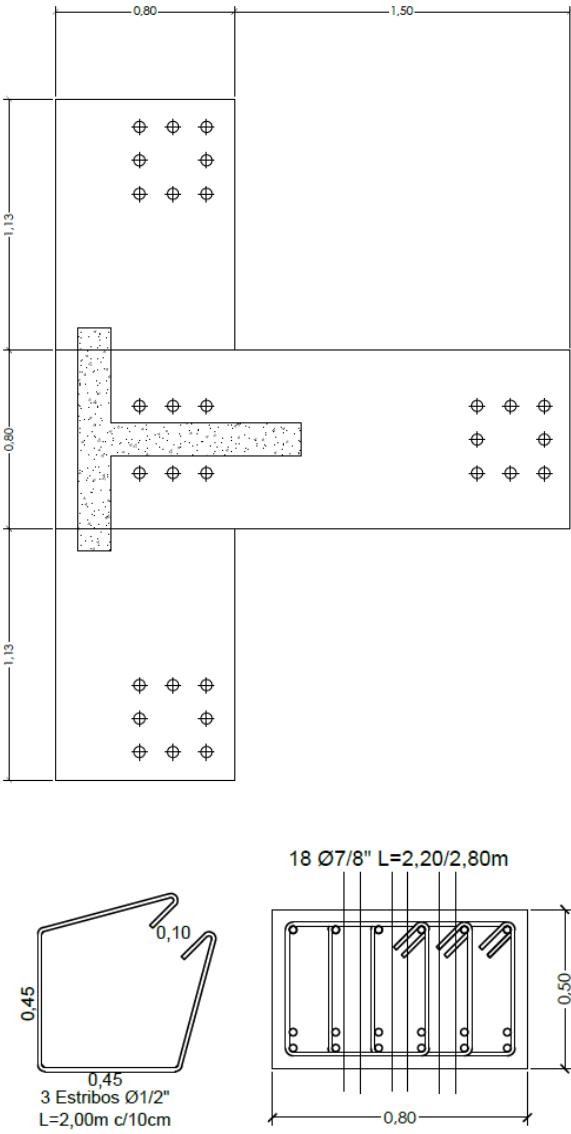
Planta y distribución del refuerzo a flexión y cortante de la viga de cimentación del muro TW1.2.
